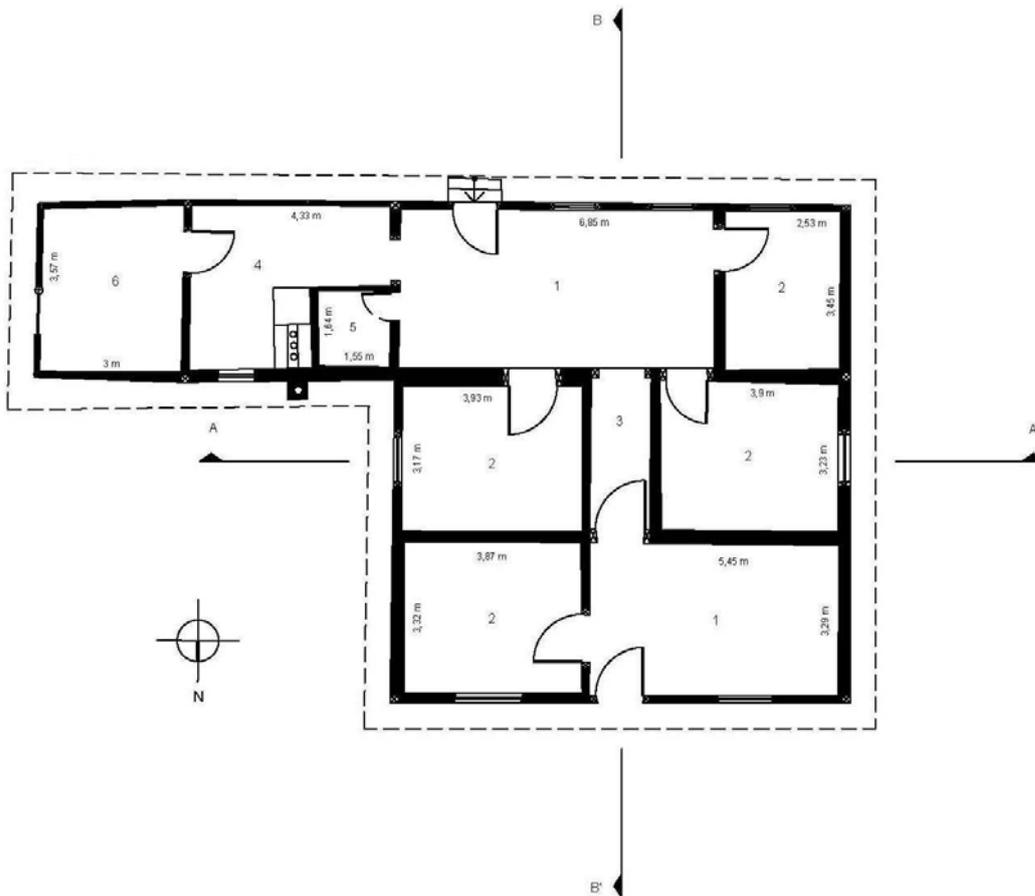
Planta baixa da casa da Fazenda Monjolo I. Área do Núcleo Básico de 73,00 m²; Área total de 137,08 m² (Acervo PROAU/FAU/UnB).
